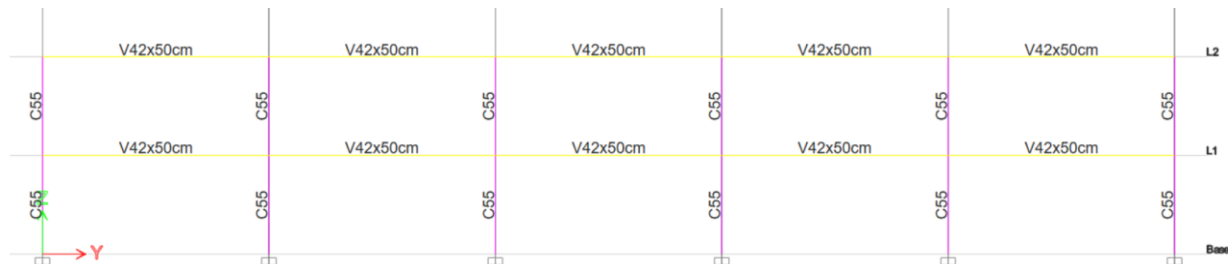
Configuración de las secciones en un pórtico exterior en dirección “y” para un edificio de 2 pisos.
